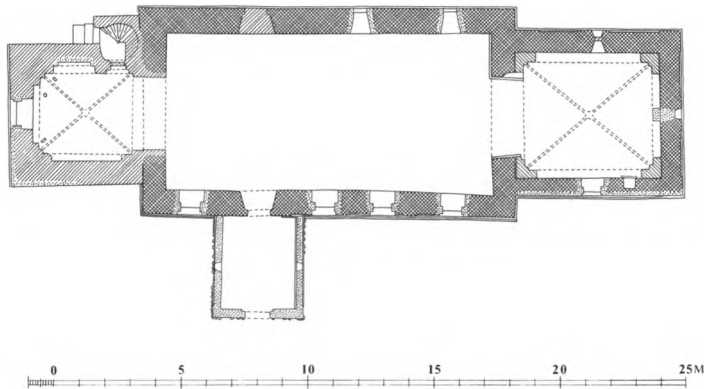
Grundplan 1:300. Målt af Søren Gottfred Petersen 1977. Tegnet af MN 1986. — *Grundriss 1:300.
